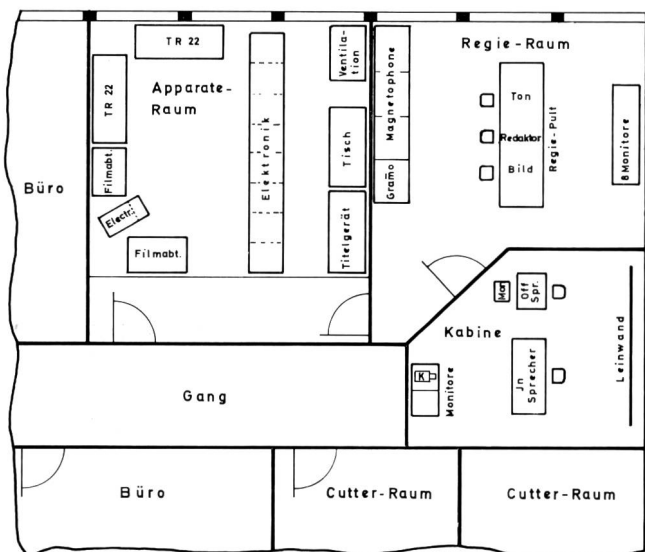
Grundriss Tagesschau-Sendekomplex. Er befindet sich unmittelbar neben den übrigen Räumen der Tagesschau des Schweizer Fernsehens
